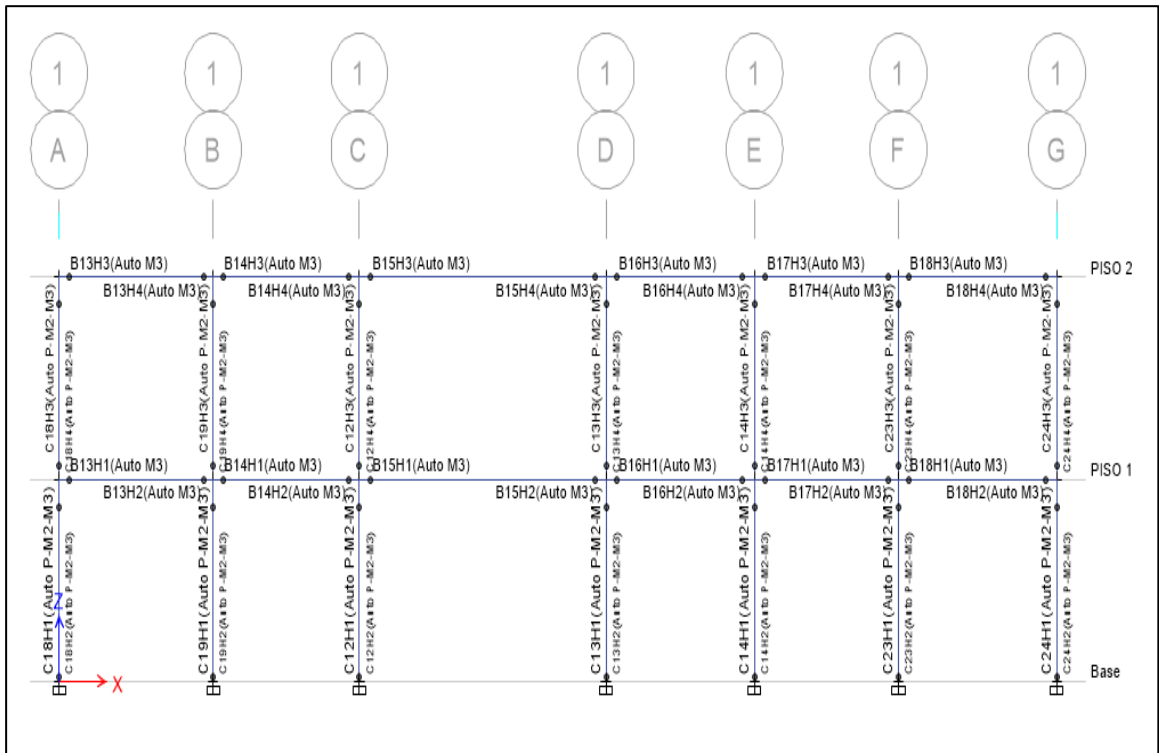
Ubicación de las rótulas plásticas en las columnas en el eje x-x. Fuente:
